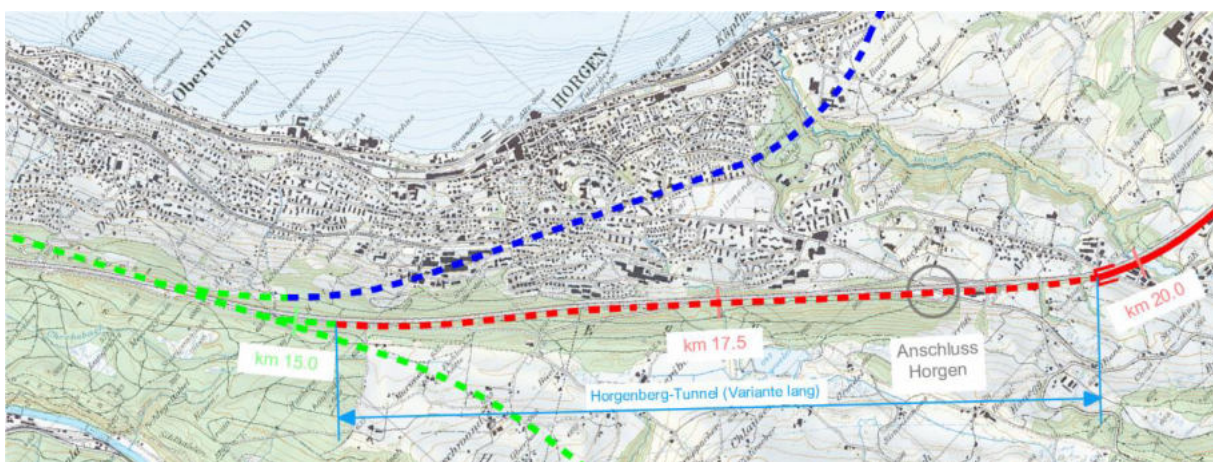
Situationsplan Horgenberg-Tunnel (Variante lang)
